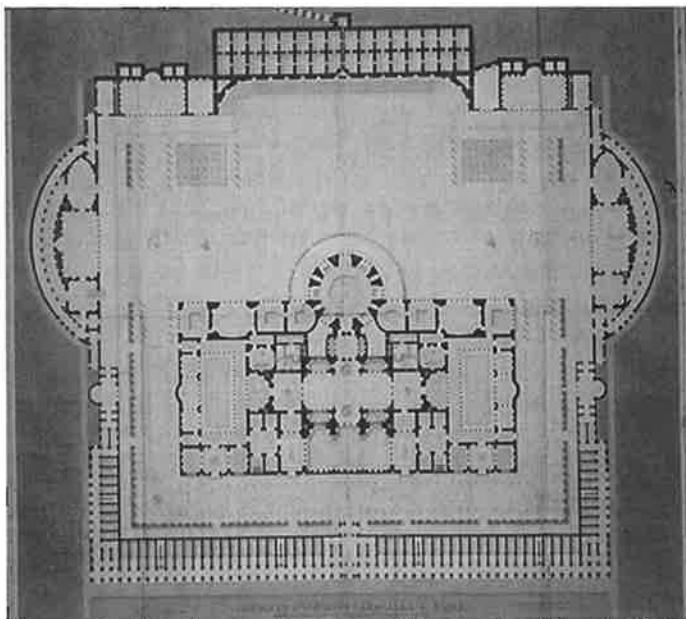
Plan du complexe par Guillaume-Abel Blouet, 1825.
